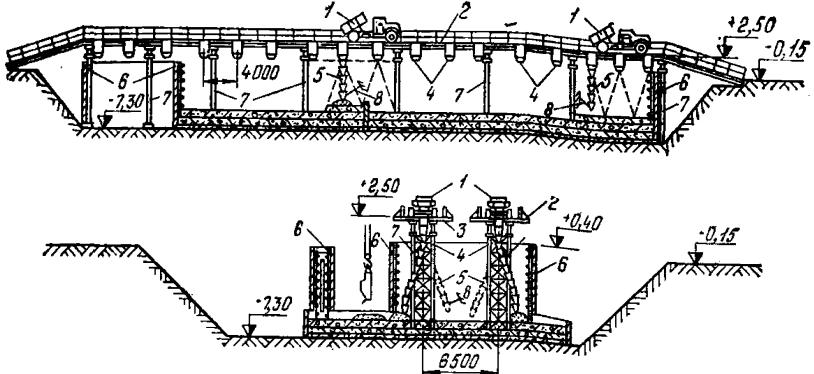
Схема бетонирования фундамента под воздухонагреватели с моста-эстакады
